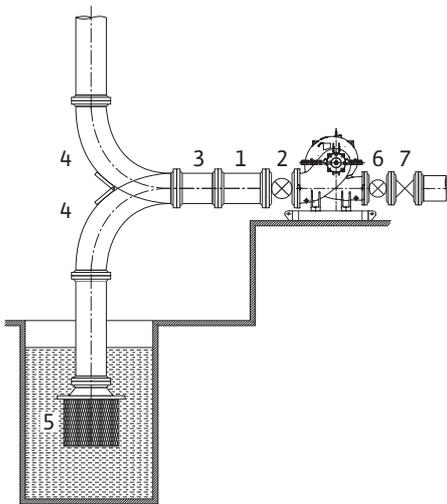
Grundlegende Anordnung einer Pumpeninstallation
